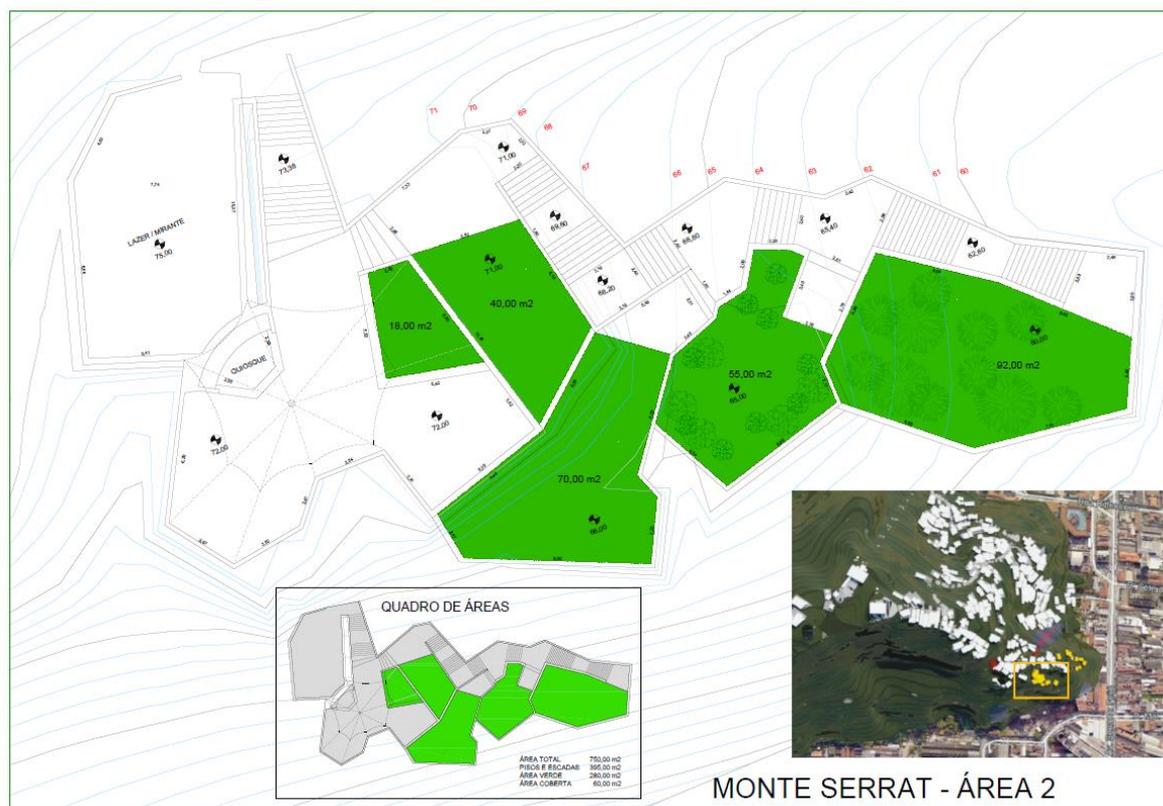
Planta baixa demonstrando a área 2 de intervenção do projeto, com o metro quadrado por porção do terreno (foto: Arquiteto Aguinaldo, Prefeitura de Santos)
